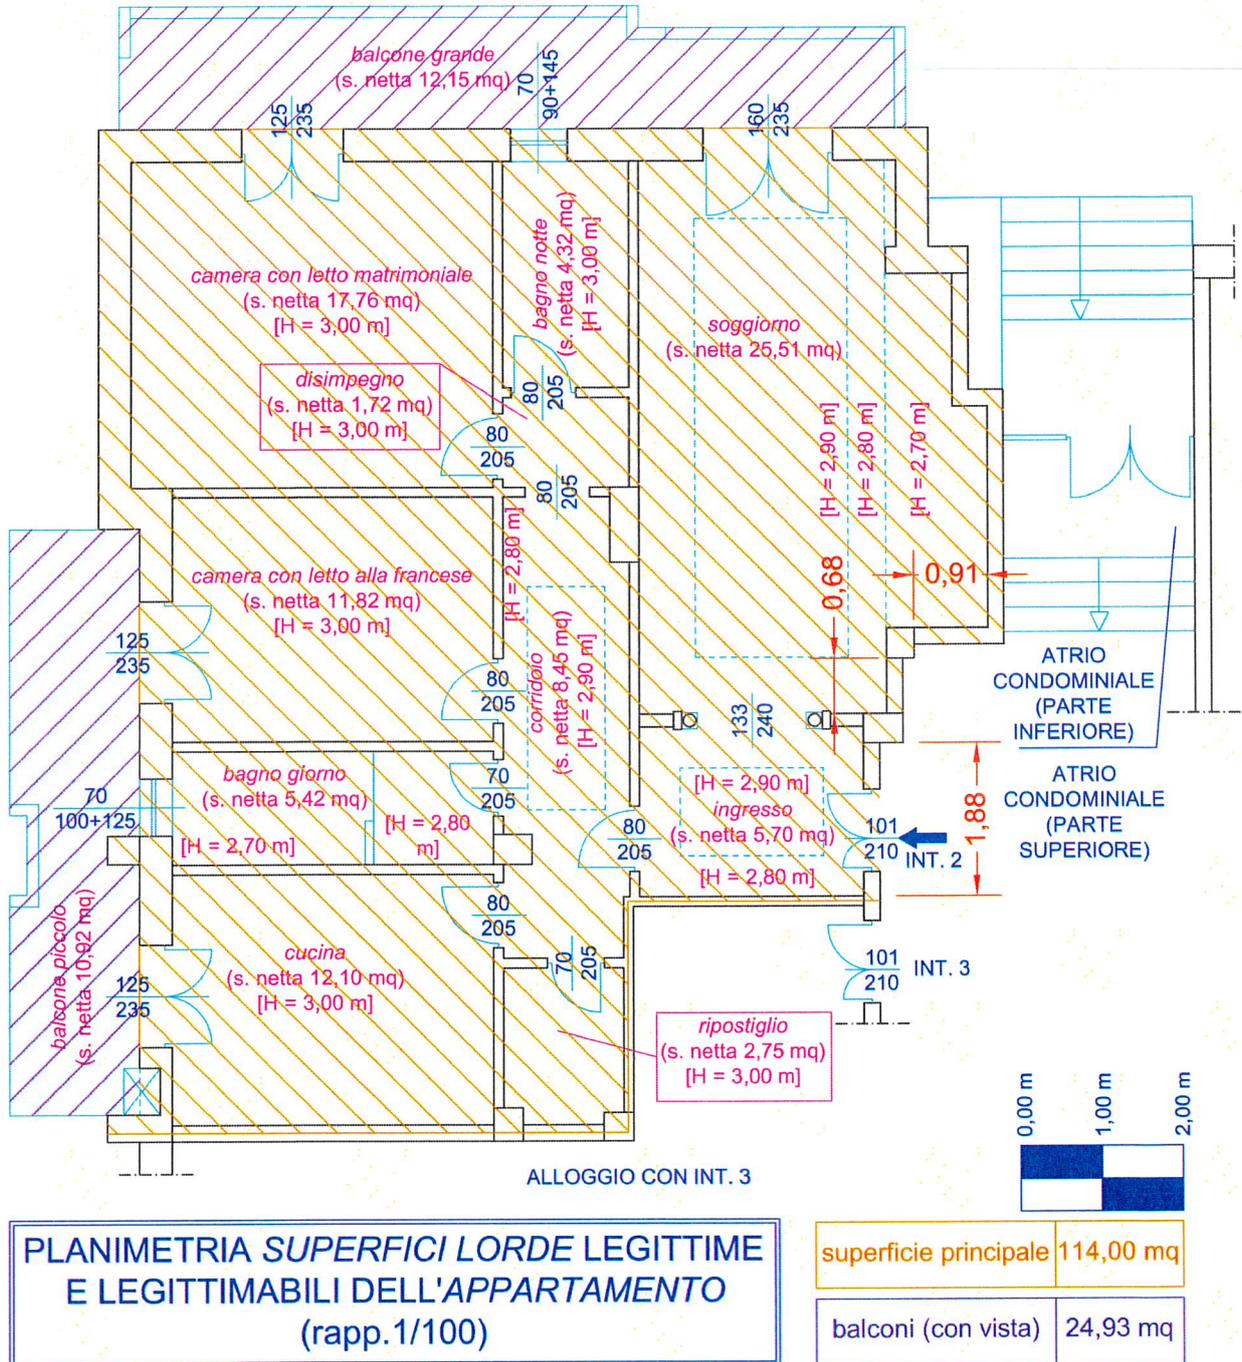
Planimetria urbanistica attuale delle superfici lorde legittime e legittimabili dell'appartamento risalente al sopralluogo del 16.12.2022
